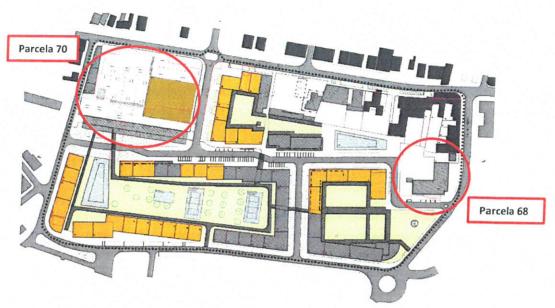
Planta de Implantação da proposta de Alteração do PPSS\_Junho2019
